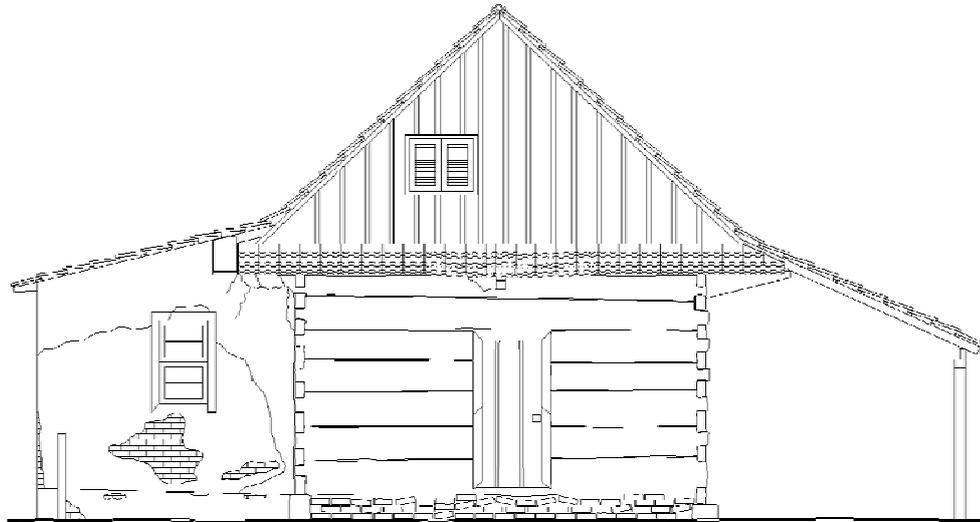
ELEVAÇÃO FRONTAL (NORDESTE)
